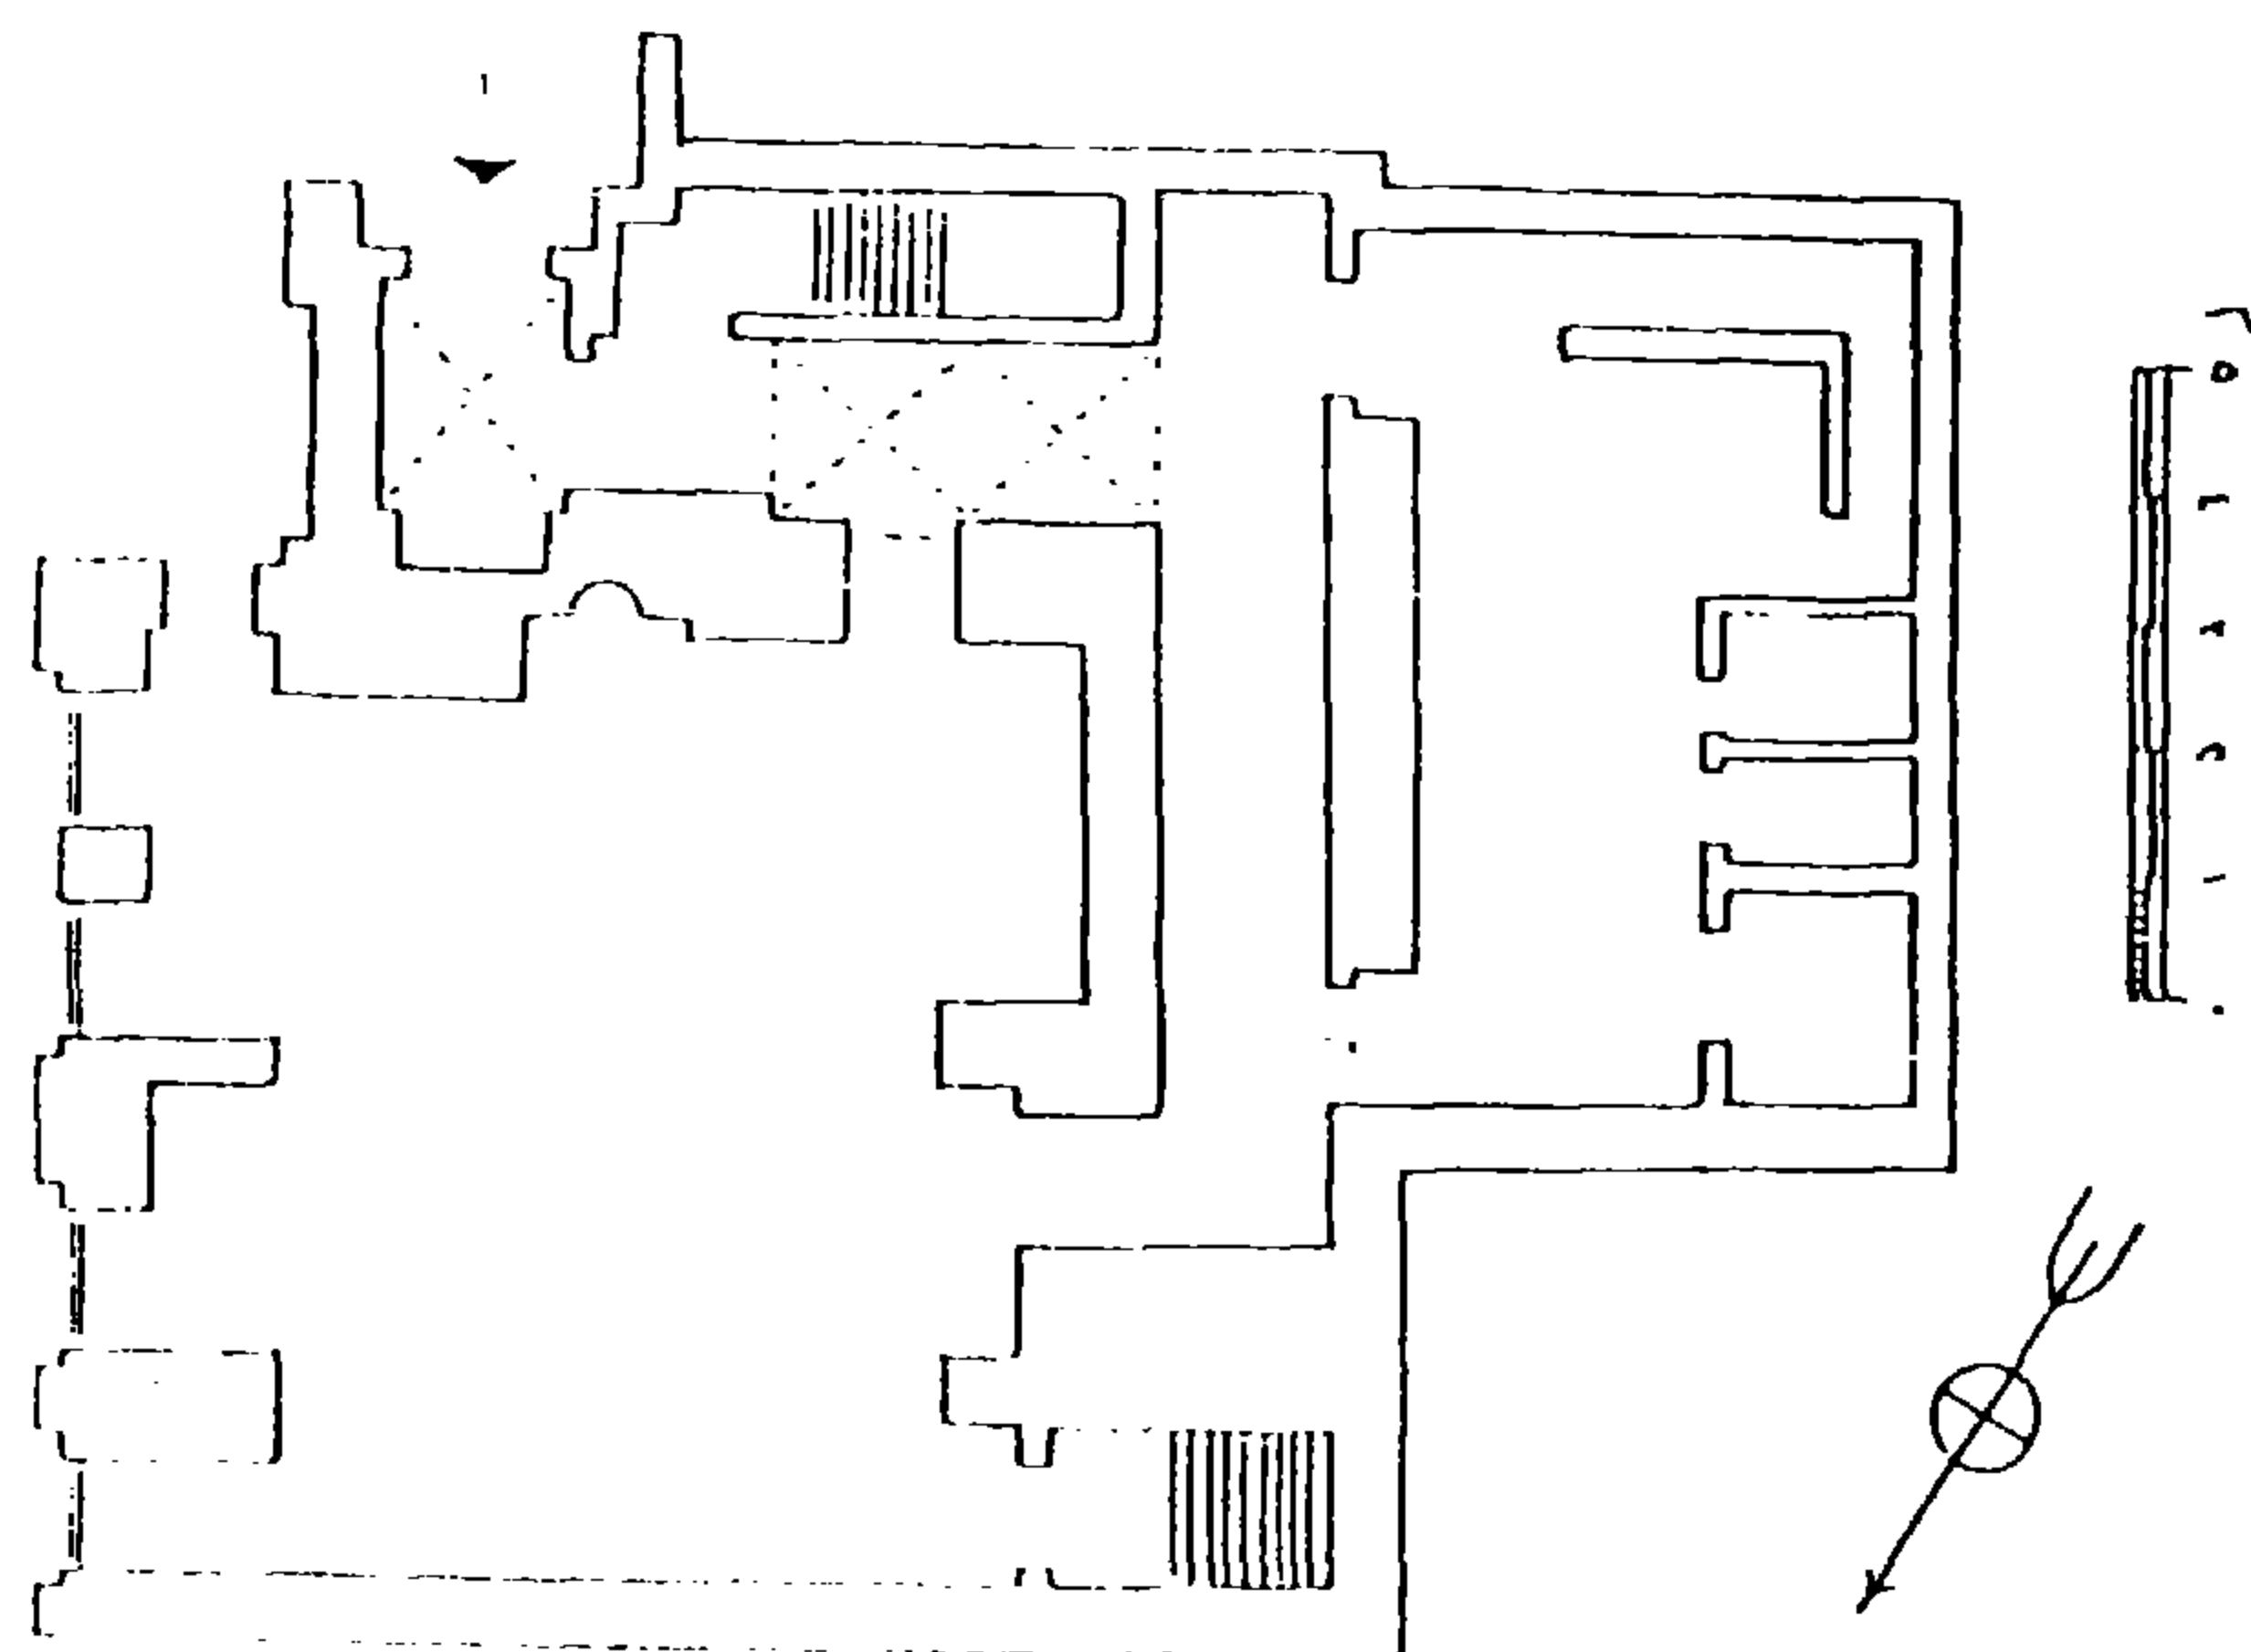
المسقط الأفقي لجامع داود باشا
